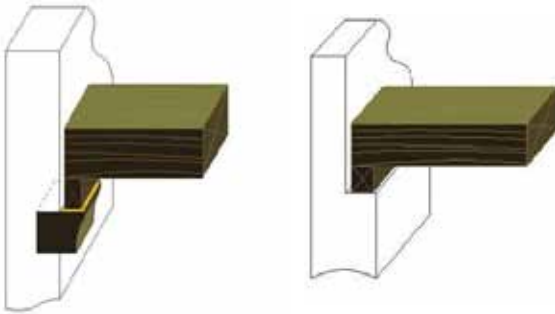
Apoyo de vigas sobre arrastres de madera (Peraza, 2001).
